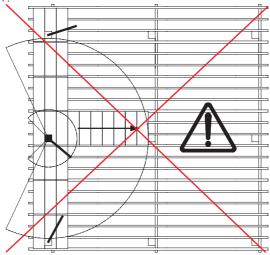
Proceso de armado de cubierta después de cambiar el punto de anclaje.
